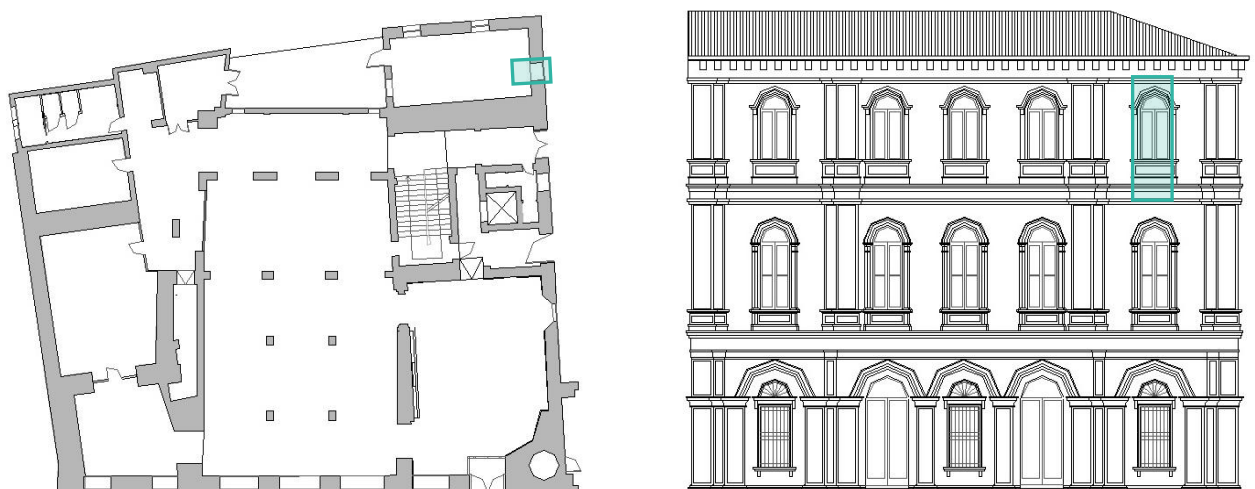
Individuazione macroelemento, pianta e prospetto
